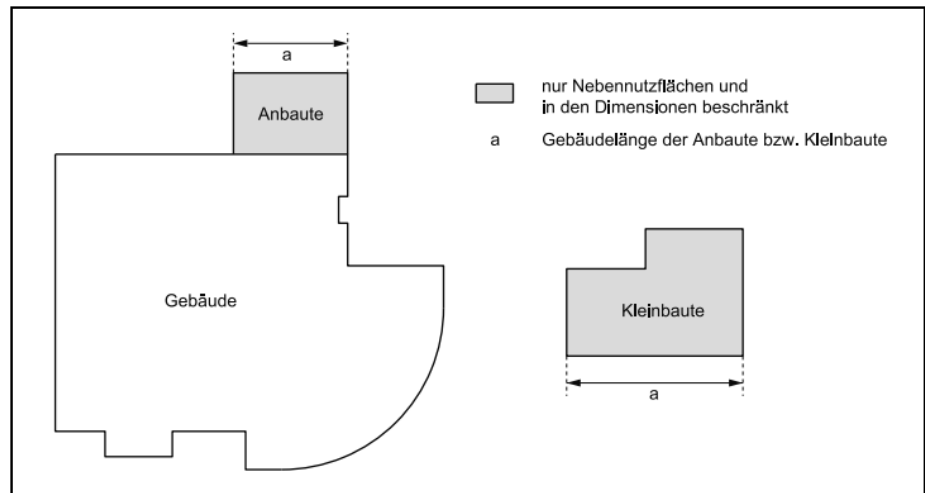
Schema Gebäude, Kleinbauten und Anbauten gemäss §§2, 2a ABV)
